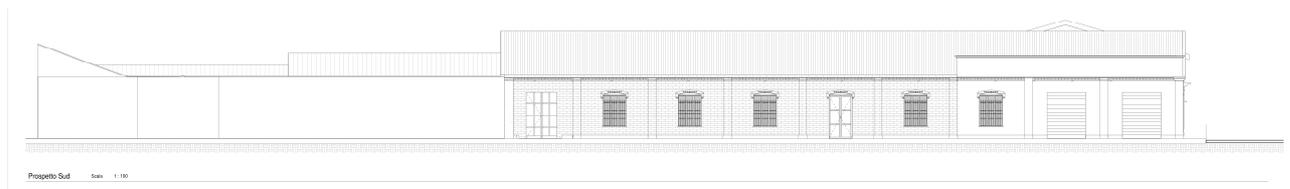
Prospetto sud (Tav. n°3 scala 1:100)
